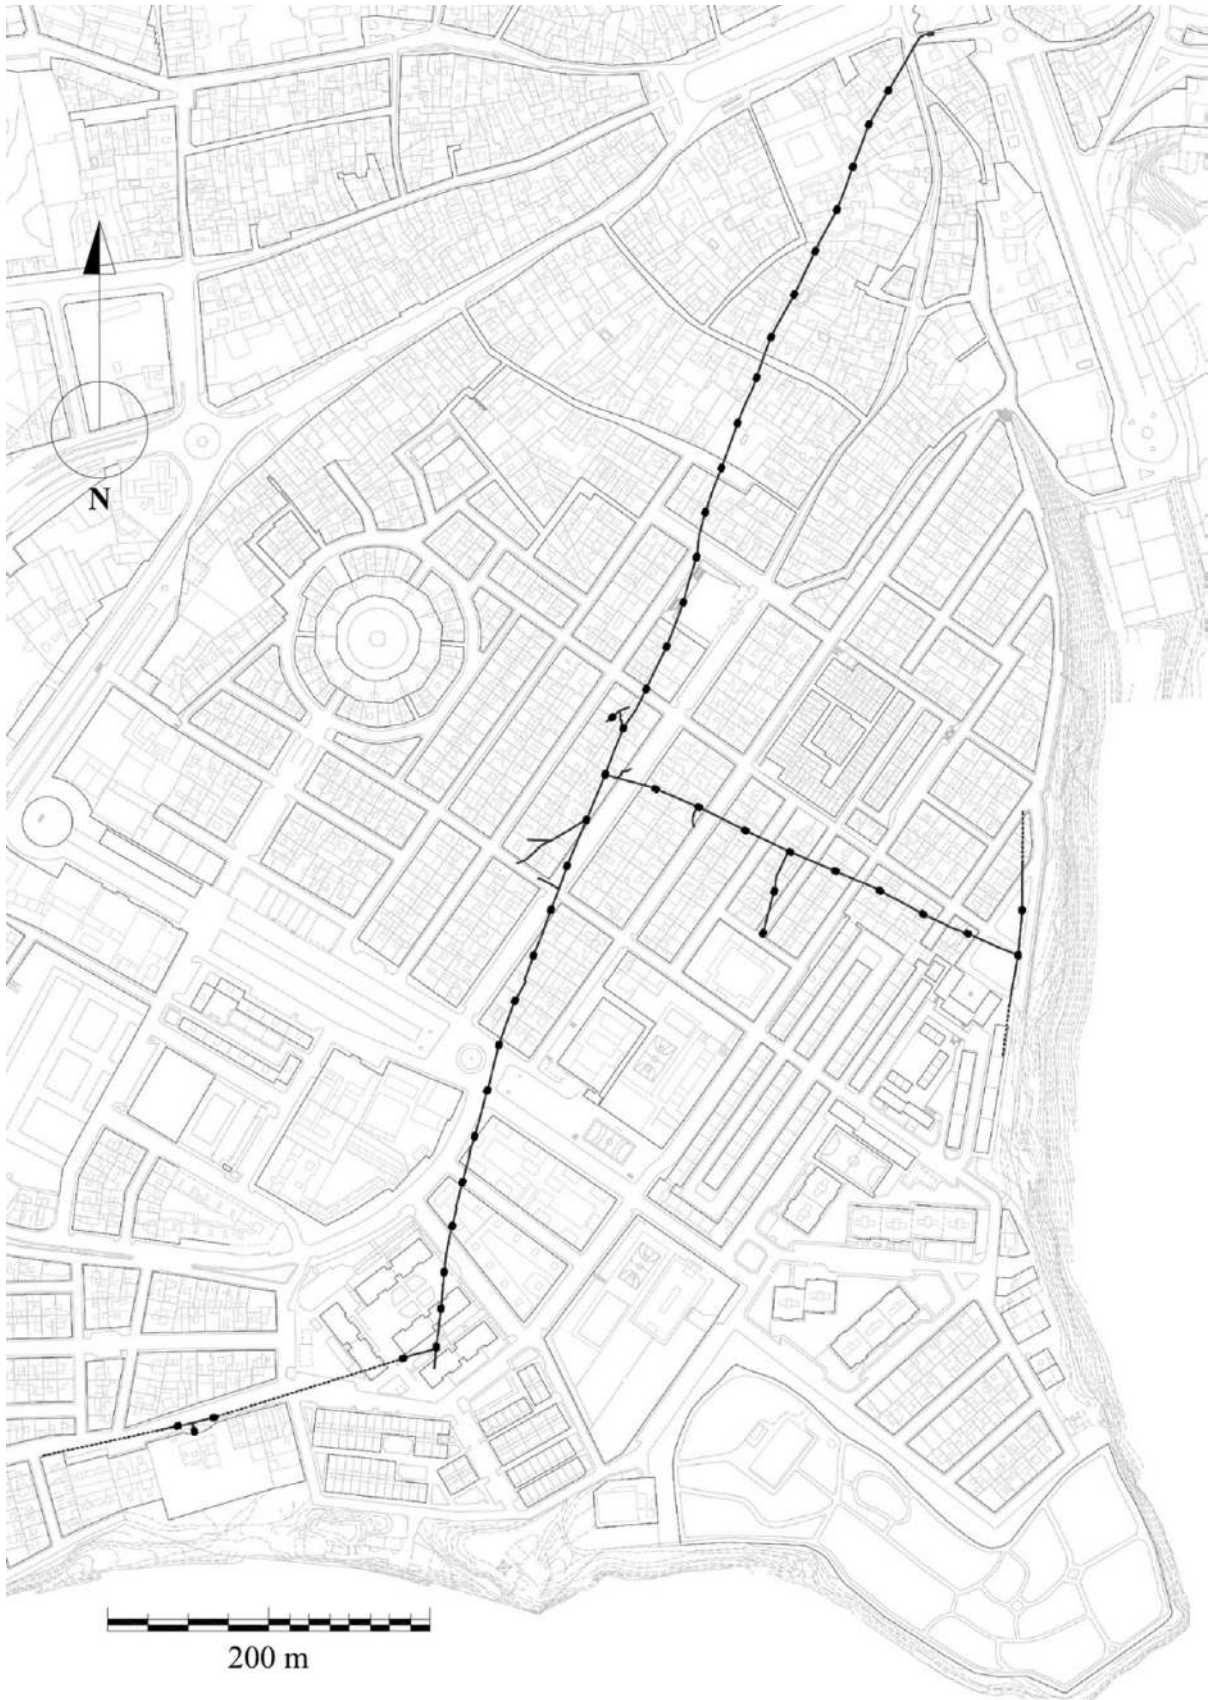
Planta de la mina de San Antón sobre planimetría catastral. Elaboración de J. Millán, J. M. Román y A. Román.
